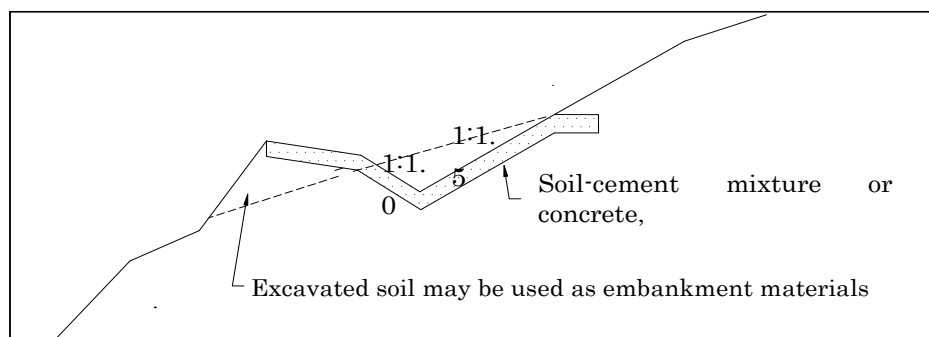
14 Canal de drenaje con mezcla de cemento del suelo, GENSAI, 2018
